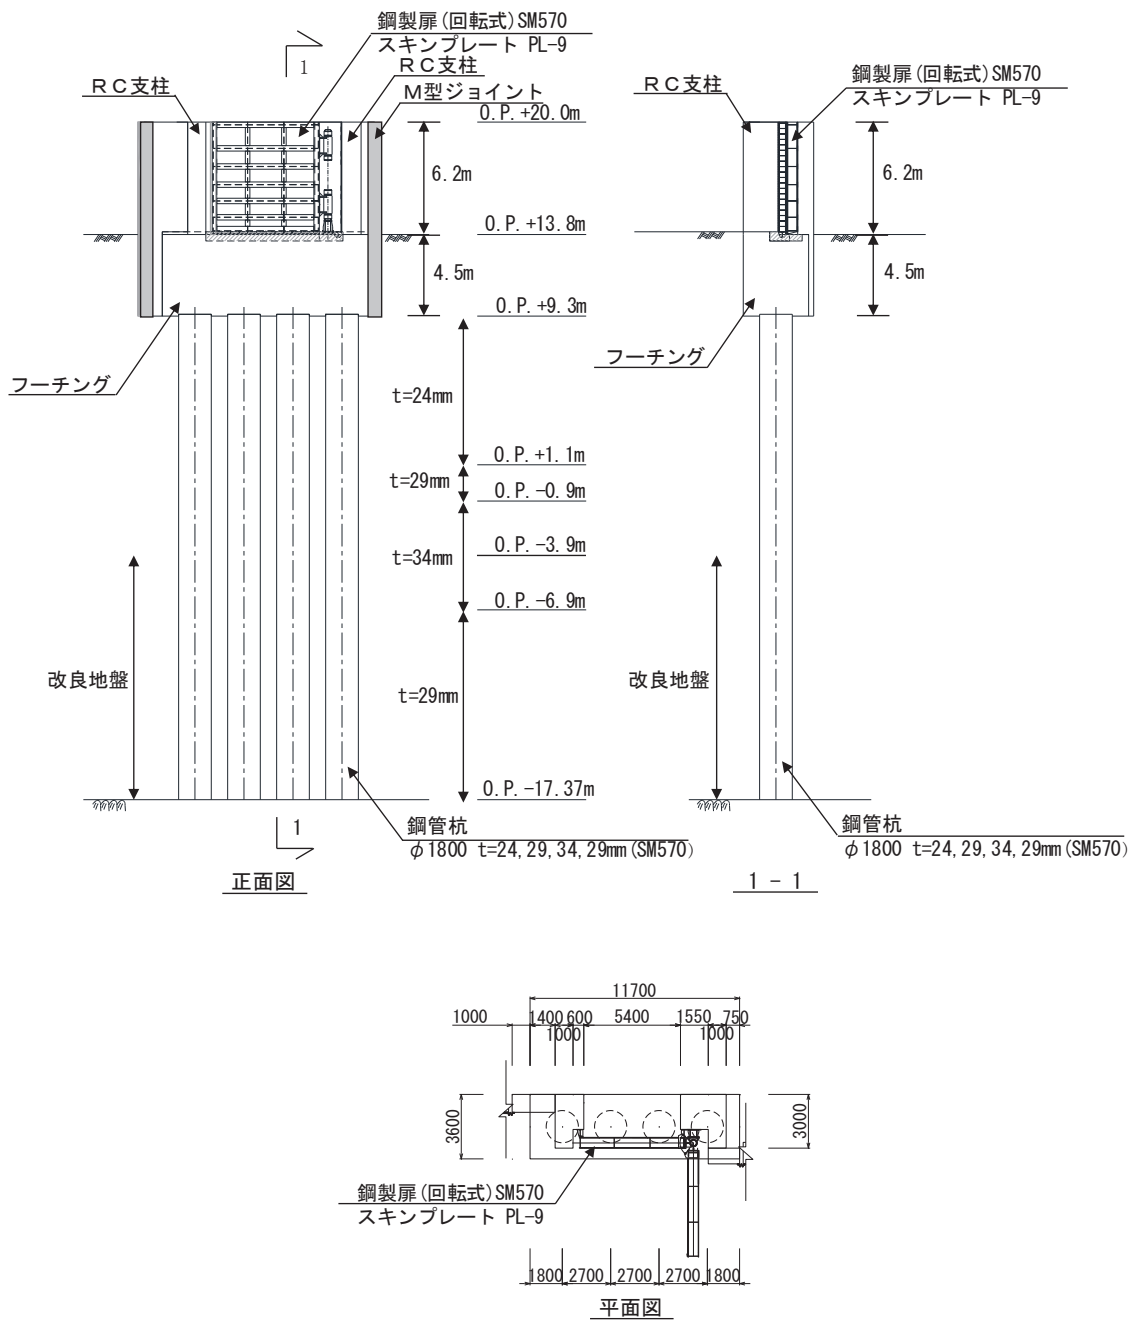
(1) 鋼製扉 3 の構造図 (正面図及び断面図, 平面図)
